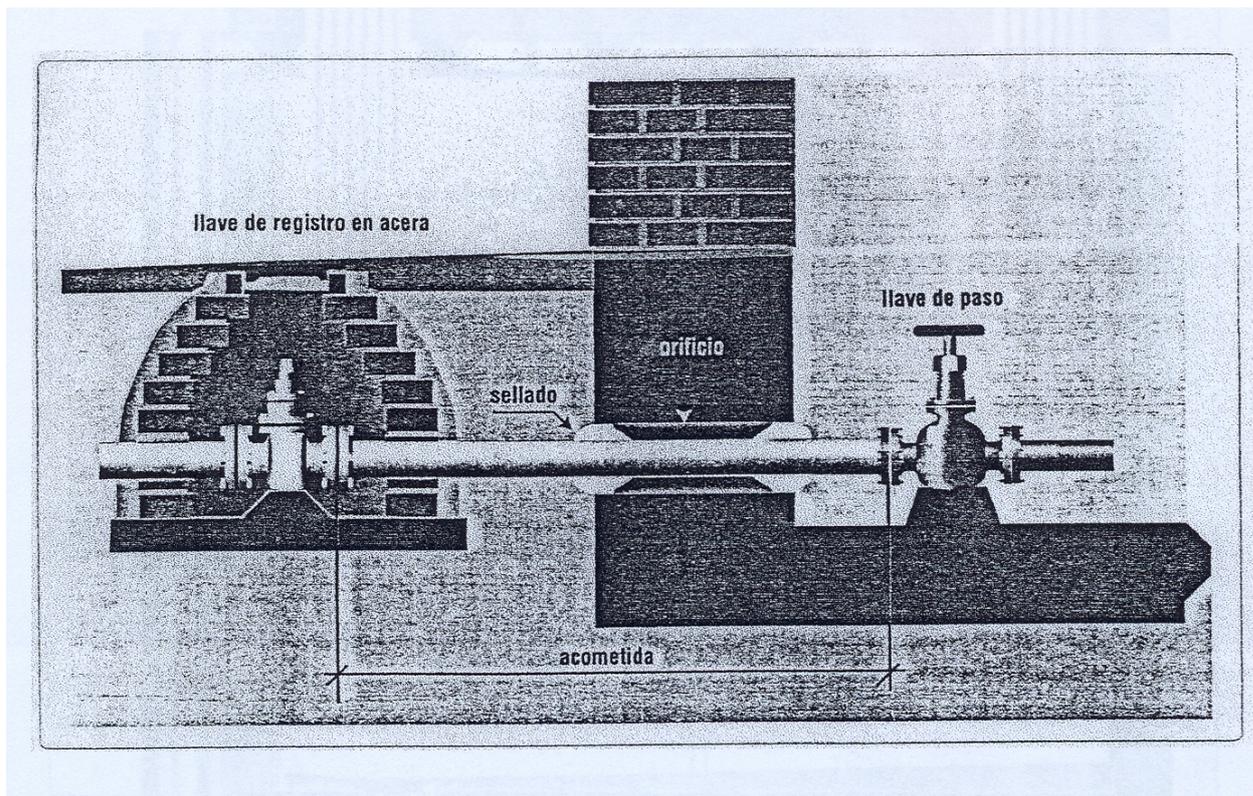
Disposición de acometida atravesando el muro del edificio⁸.
